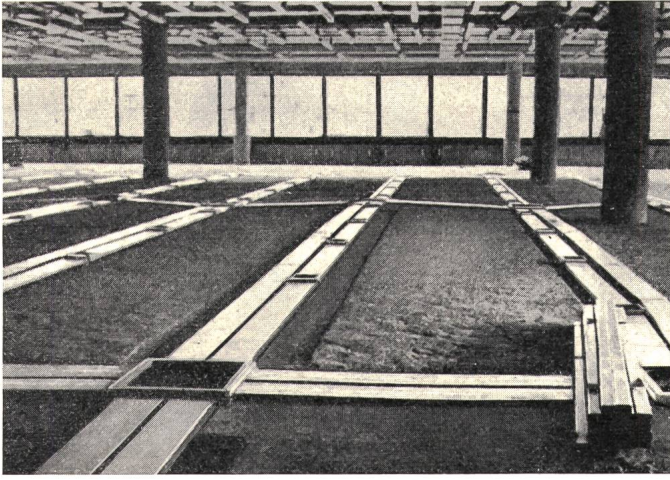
Auf den Rohbeton verlegtes Bodenkanal/Bodenkasten-Installationssystem
